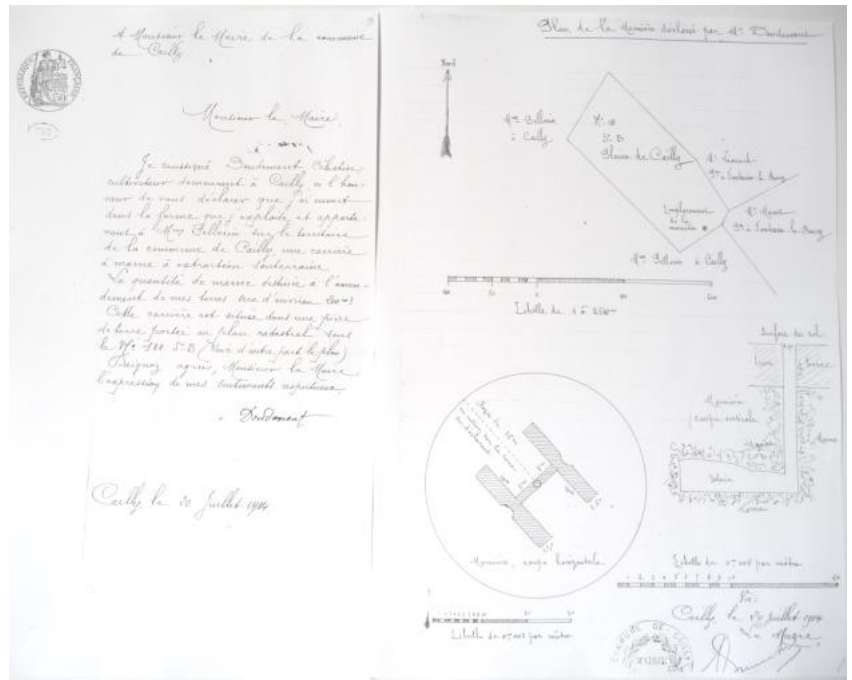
Exemple d'archive pouvant être rencontré dans les archives communales anciennes : déclaration, un plan de localisation, une coupe et un plan d'extension (source Explor-e)
